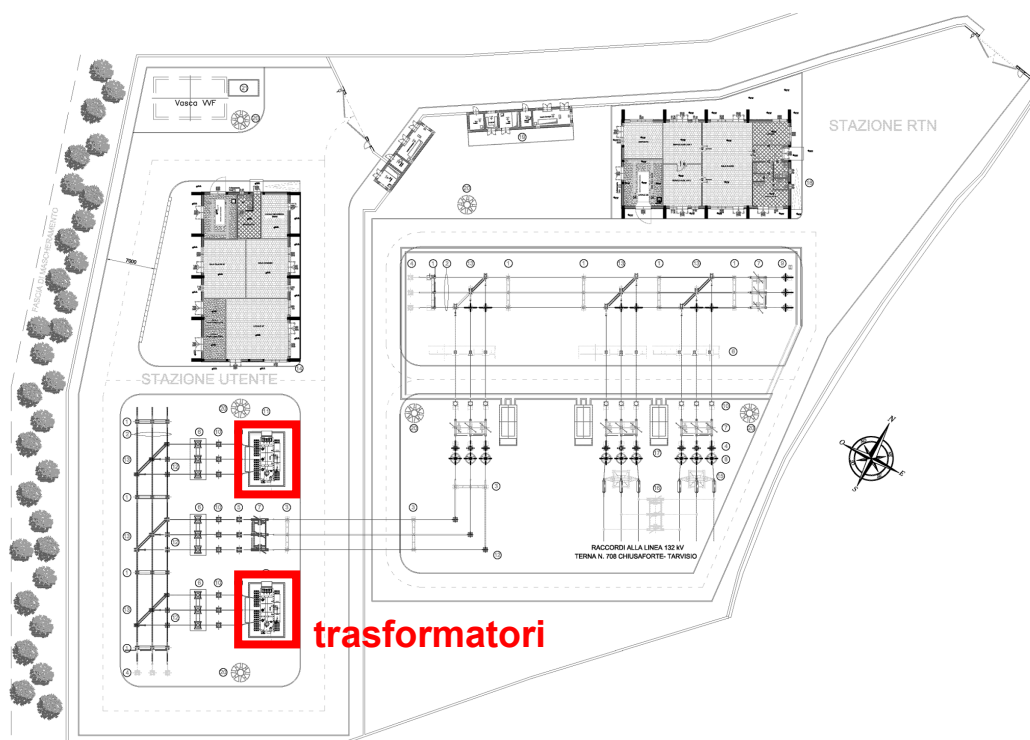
Planimetria della nuova area delle stazioni RTN e utente con la localizzazione delle sorgenti rumorose rilevanti (in rosso)
